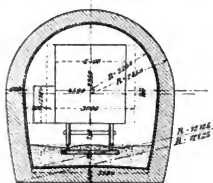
Tunnelquerschnitt für eingleisige Strecken mit Bogen von 30 m Halbmesser, 1:150.
